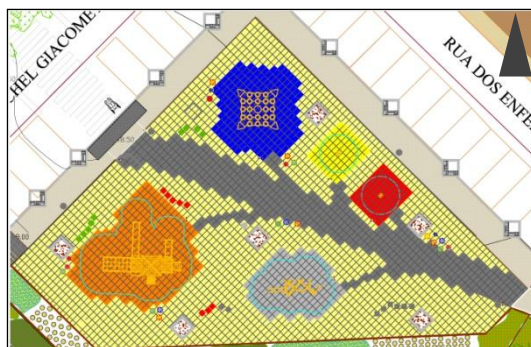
Pavimento cinza escuro para o eixo principal, sendo que o restante pavimento será bege, azul, vermelho, laranja e amarelo.
